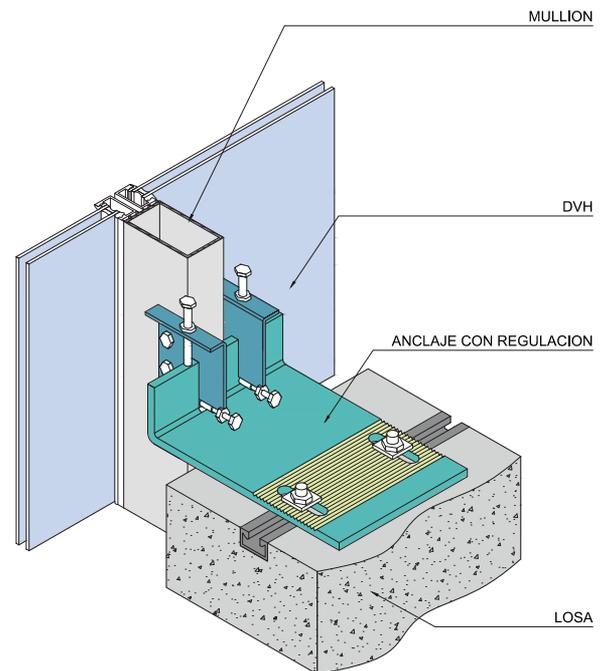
Sistema de anclaje del muro cortina a losa.
